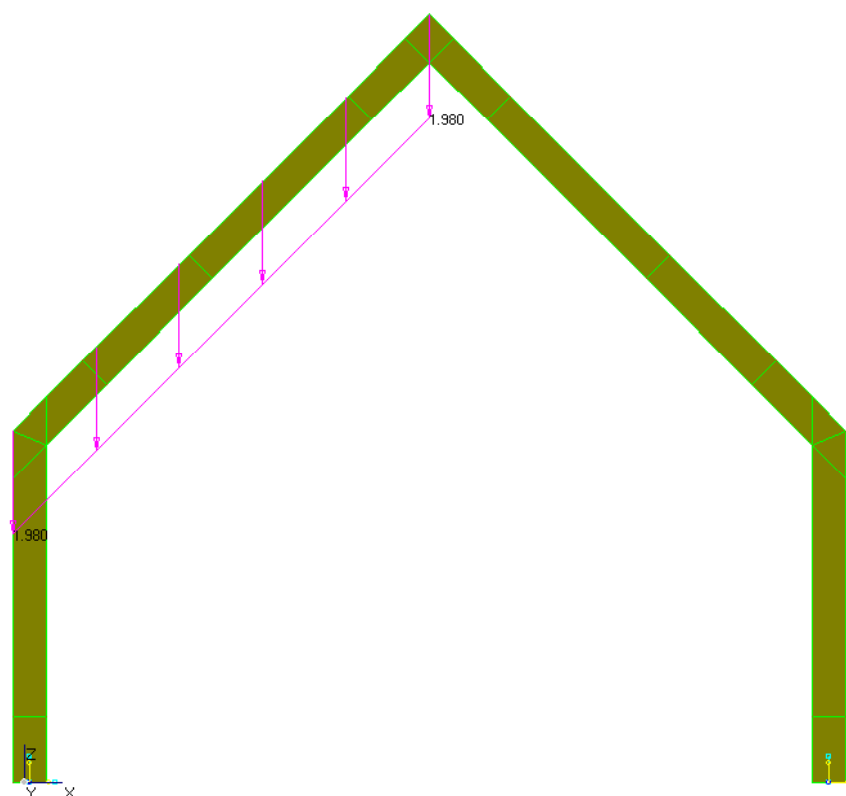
Двускатное здание с углом наклона кровли 45 град. Расчетная снеговая нагрузка snow_left, действующая по направлению оси Z, кН/м^2
